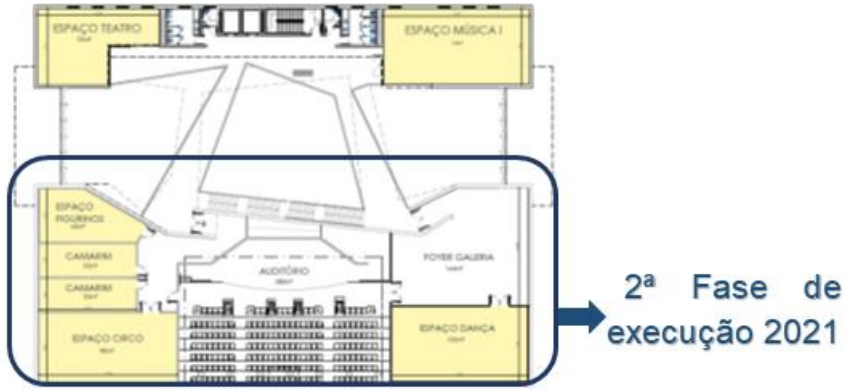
º Pavimento Anteprojeto para segunda fase de implantação
